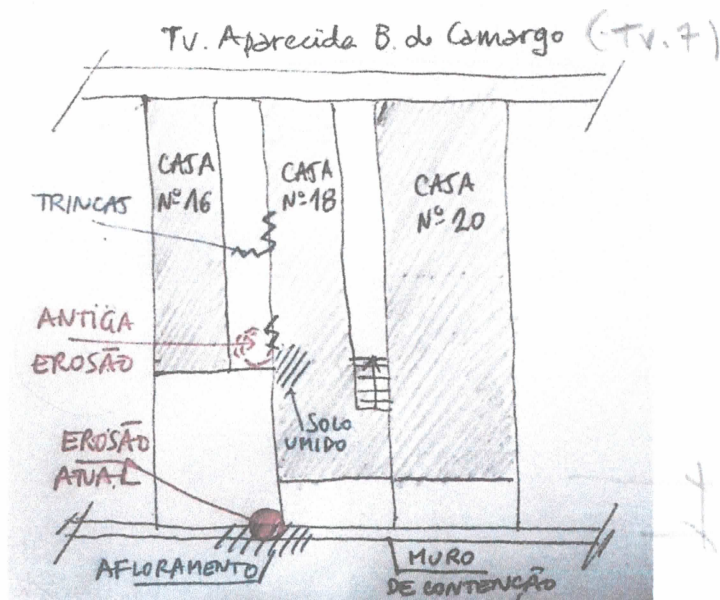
Croqui, em planta, da situação atual no entorno das casas n.16 e 18.
